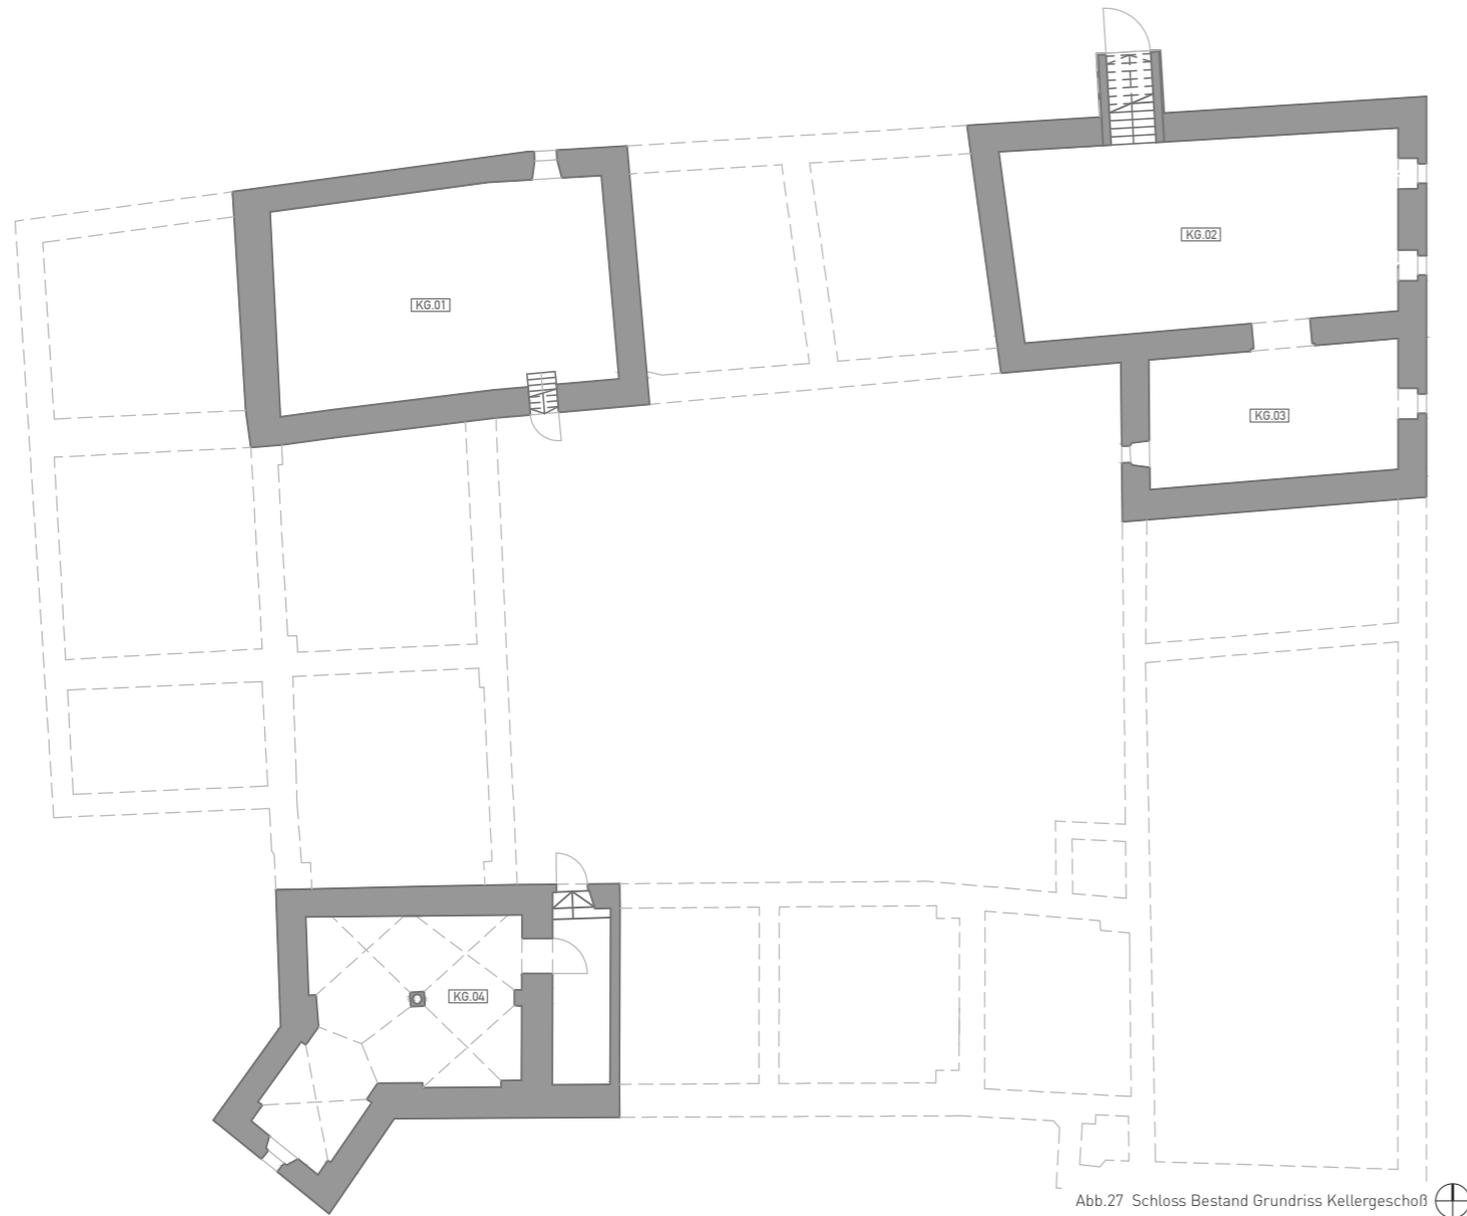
Schloss Bestand Grundriss Kellergeschoß
